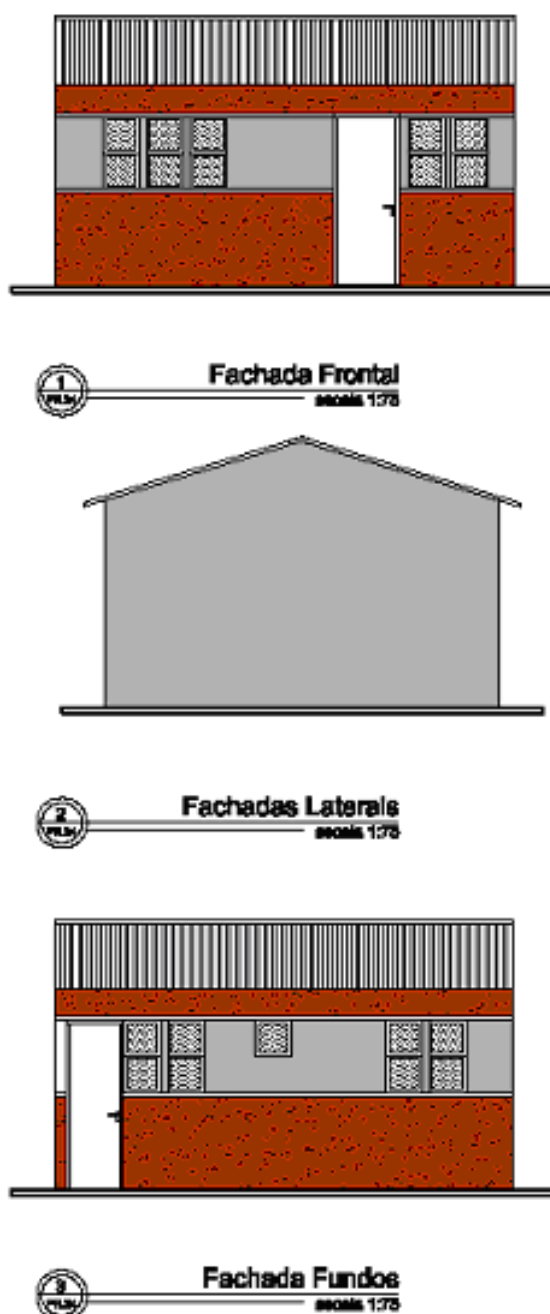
Fachadas (Fonte:Arquivo do autor, 2008).
